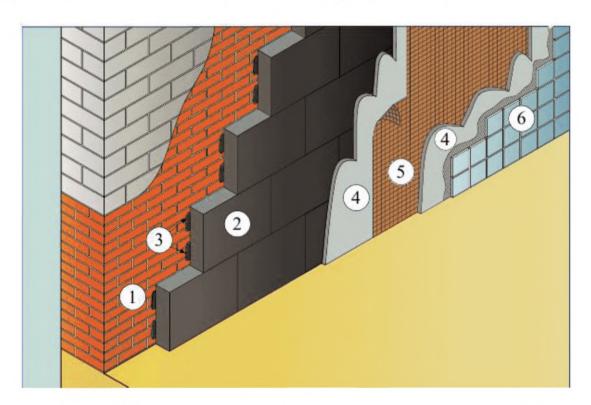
Облицовка стены, утепленной со стороны помещения плитами пеностекла НЕОПОРМ®
